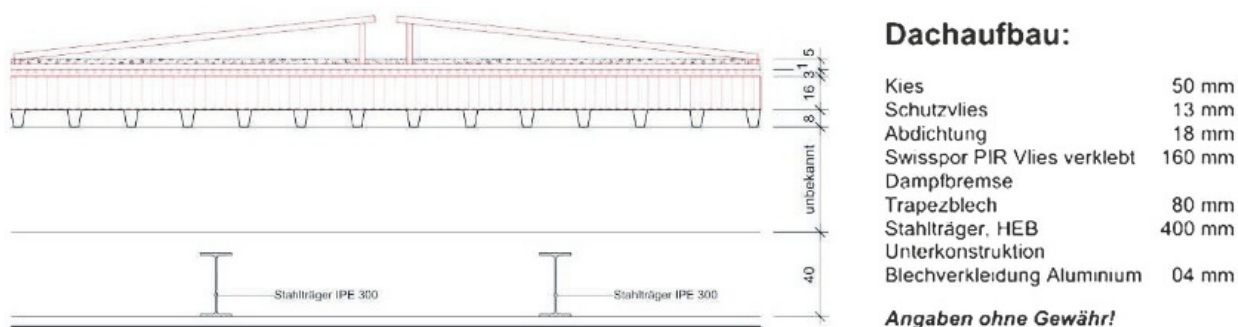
Detailschnitt mit Dachaufbau und PV-Anlage
